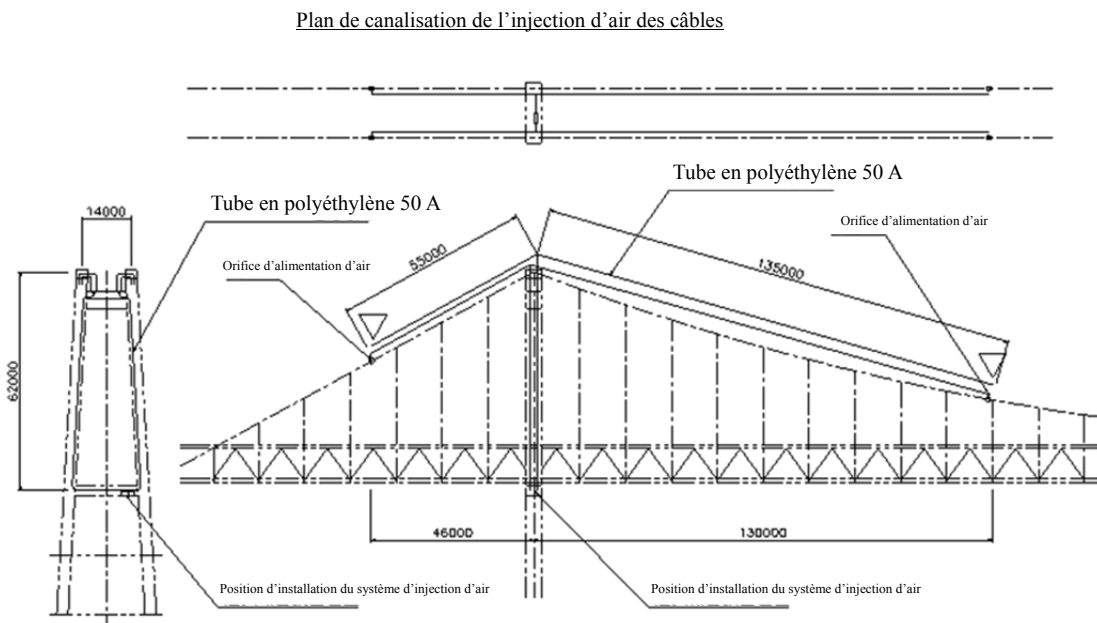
Plan schématique de canalisation du système d'injection d'air sec des câbles
